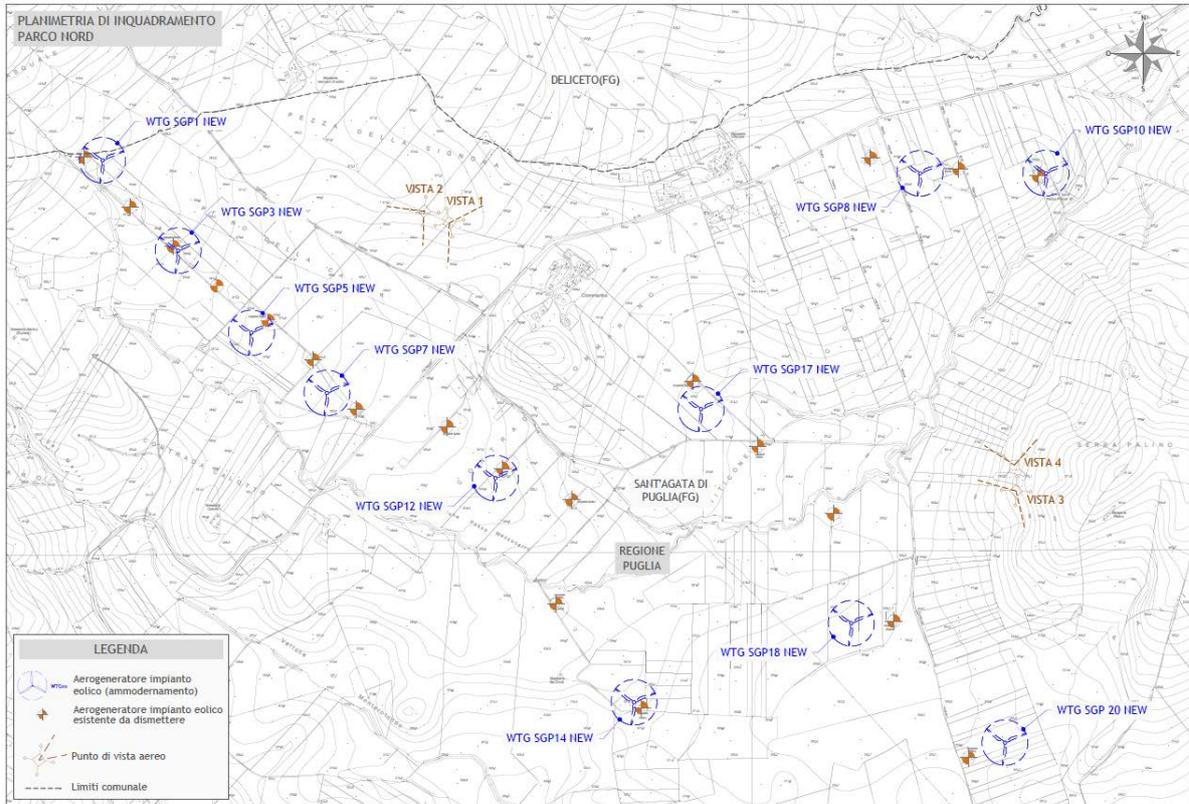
Stralcio della planimetria CTR con ubicazione punti di vista aerei per la documentazione fotografica attestante le condizioni del sito prima dell’intervento d’ammodernamento – Parco Nord
